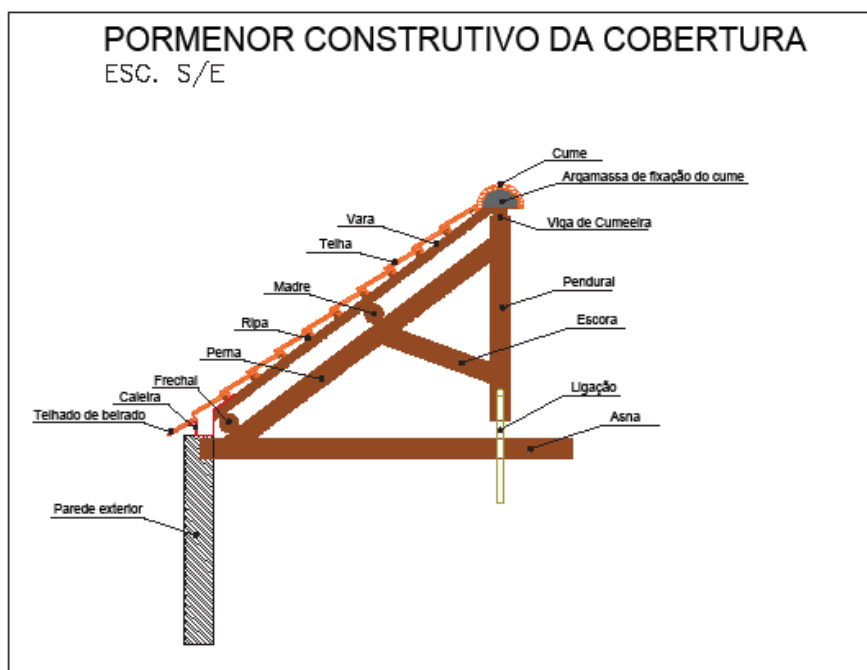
Pormenor da cobertura em madeira (antes)
